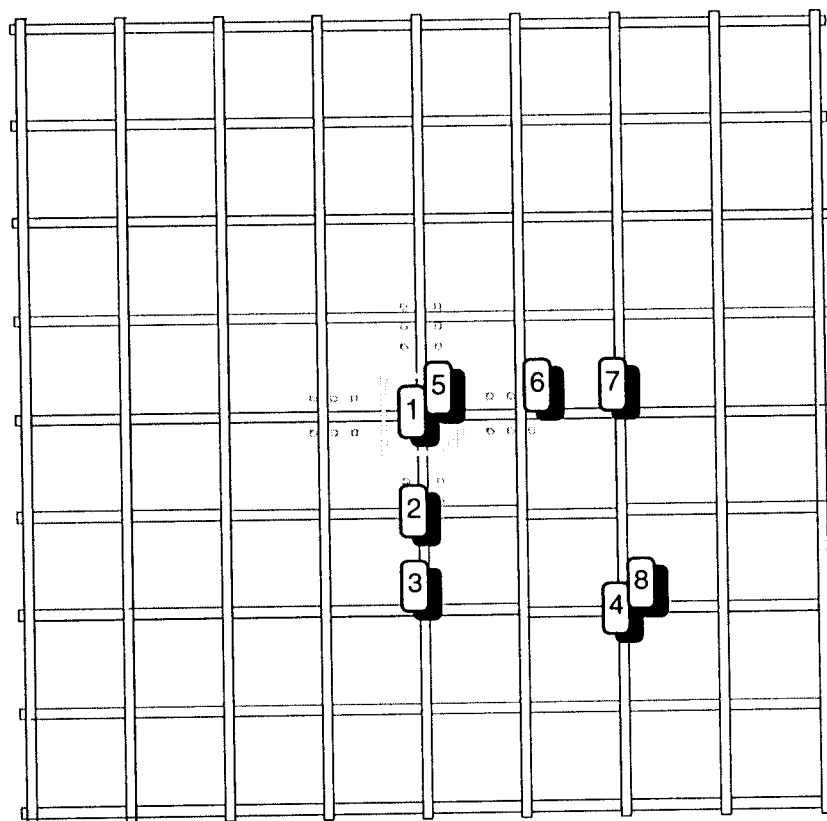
Distribuição dos pontos instrumentados na Armadura Longitudinal Tracionada do Modelo.
